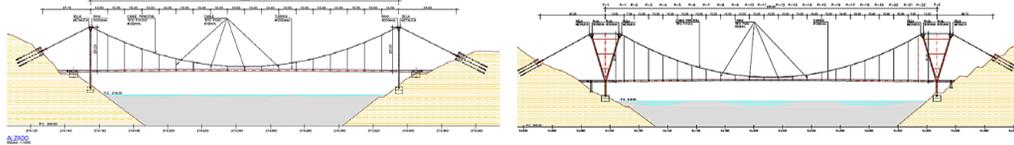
Estructuras de paso de la tubería de abastecimiento Portaje-Cáceres sobre el Almonte (180 m de vano) y sobre el Tajo (230 m de vano), en fase de proyecto. La cercanía a los puentes de la A-66 puede convertir en un desastre paisajístico la oportunidad existente de poder disfrutar de cuatro estructuras singulares en un mismo entorno.
